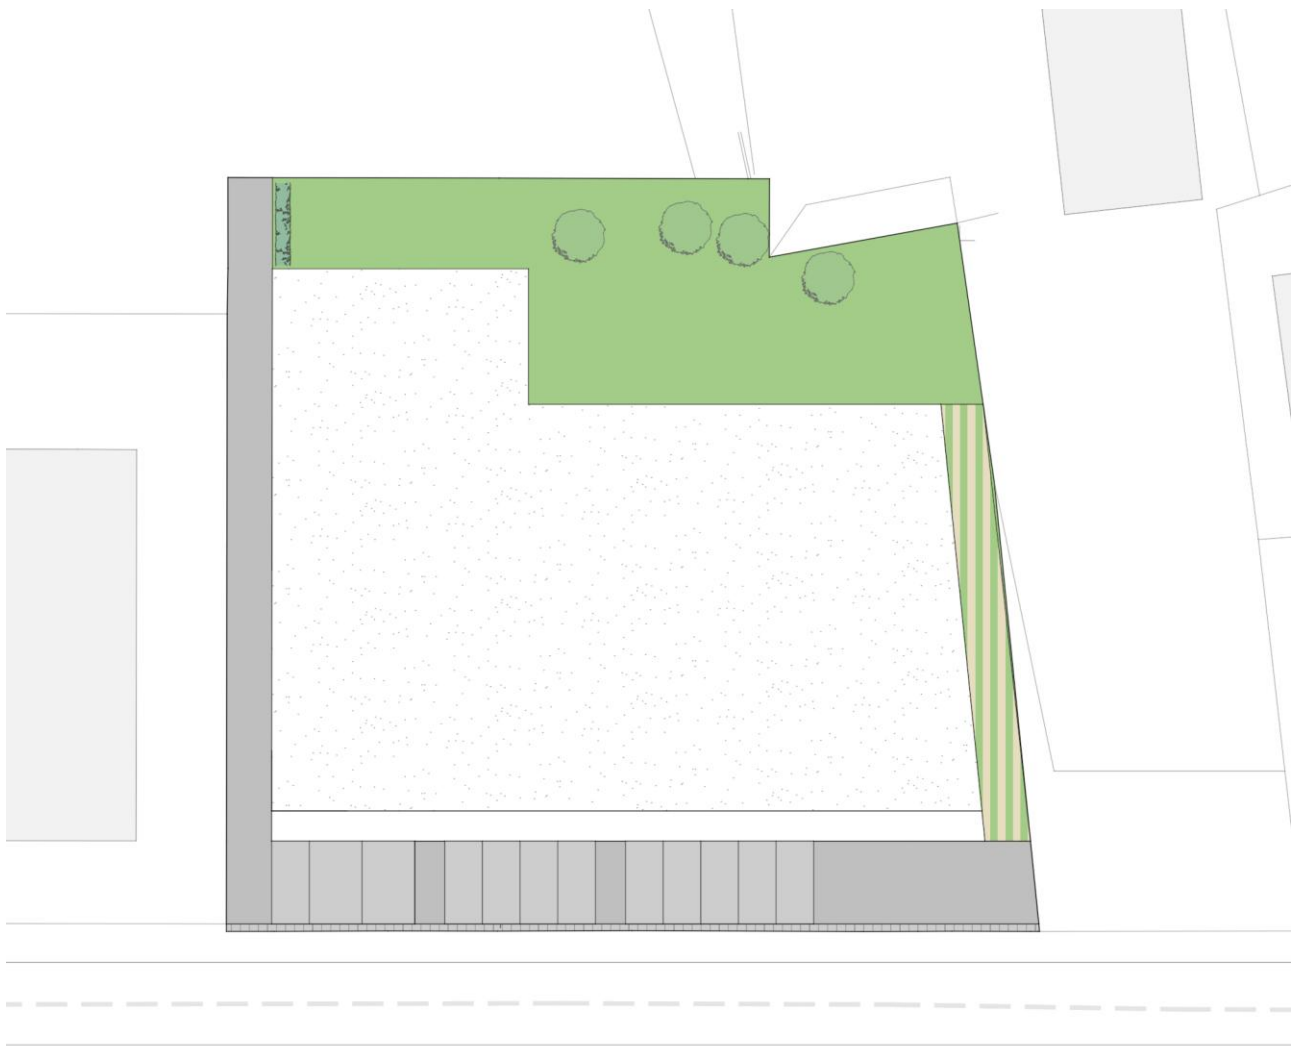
illustration plantation/verdure (source : acom ; hors échelle)
